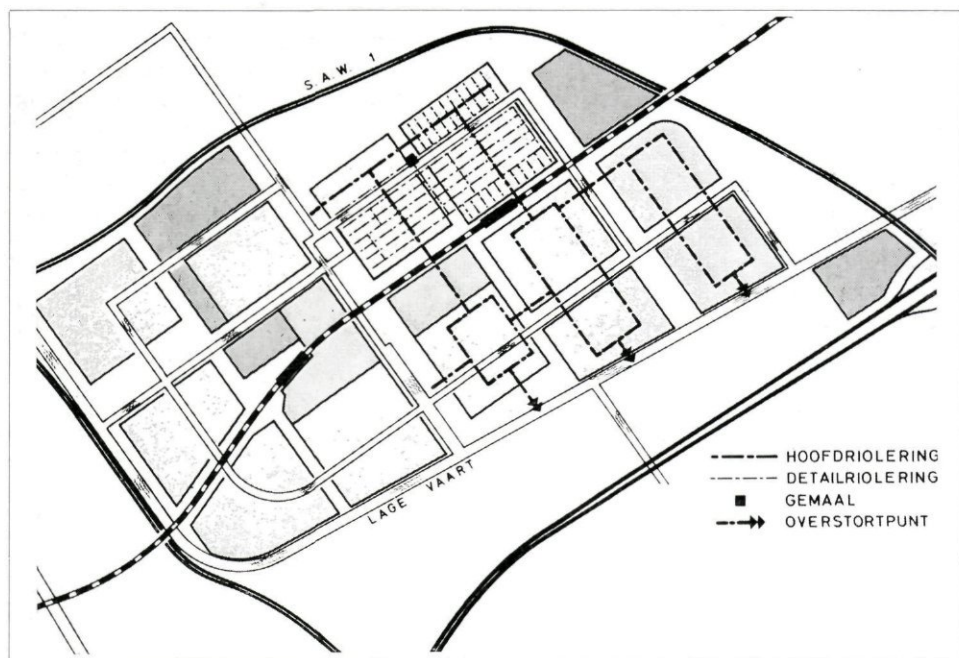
Overzicht concept ontwerp structuurplan Almere-Buiten.
